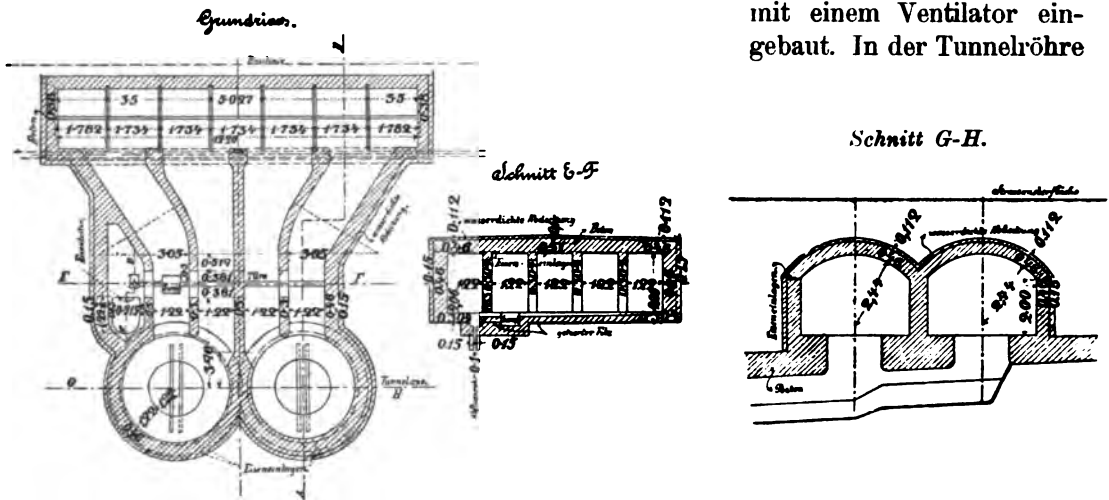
Grundriß und Schnitte der Lüftungsanlage unterhalb der Lewis-Street in East-Boston.
